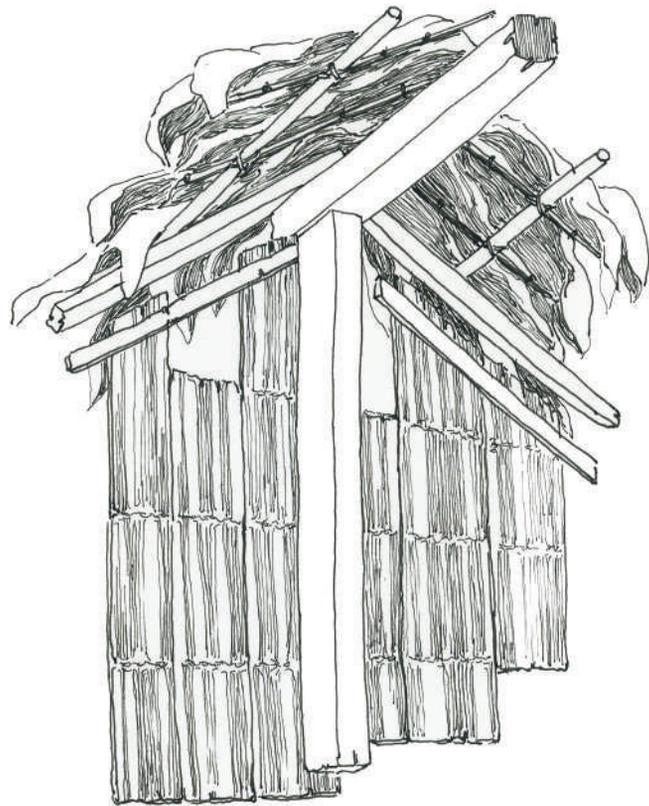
Edificación con cubierta con revestimiento de bijao.
